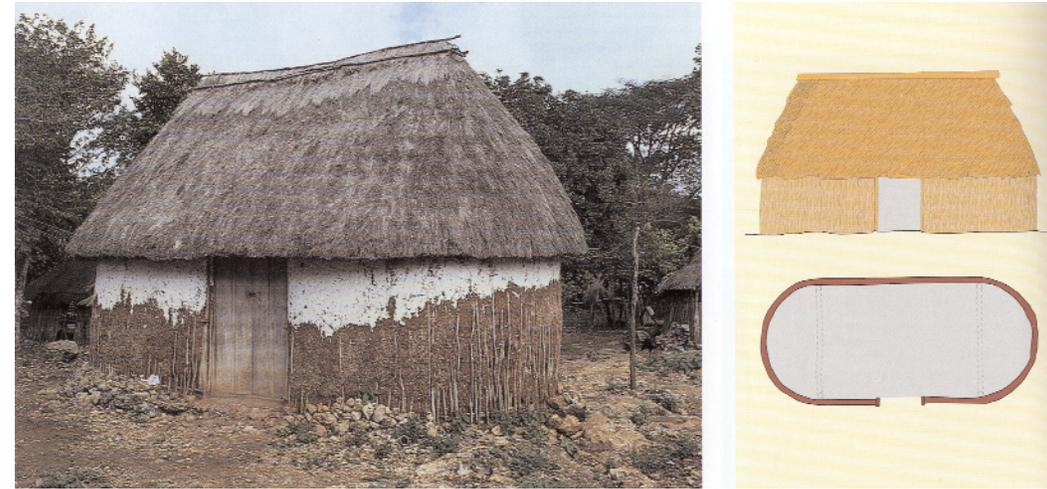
Foto, alzado y planta de la casa maya. Imagen extraída de Henry Stierlin (2001).
